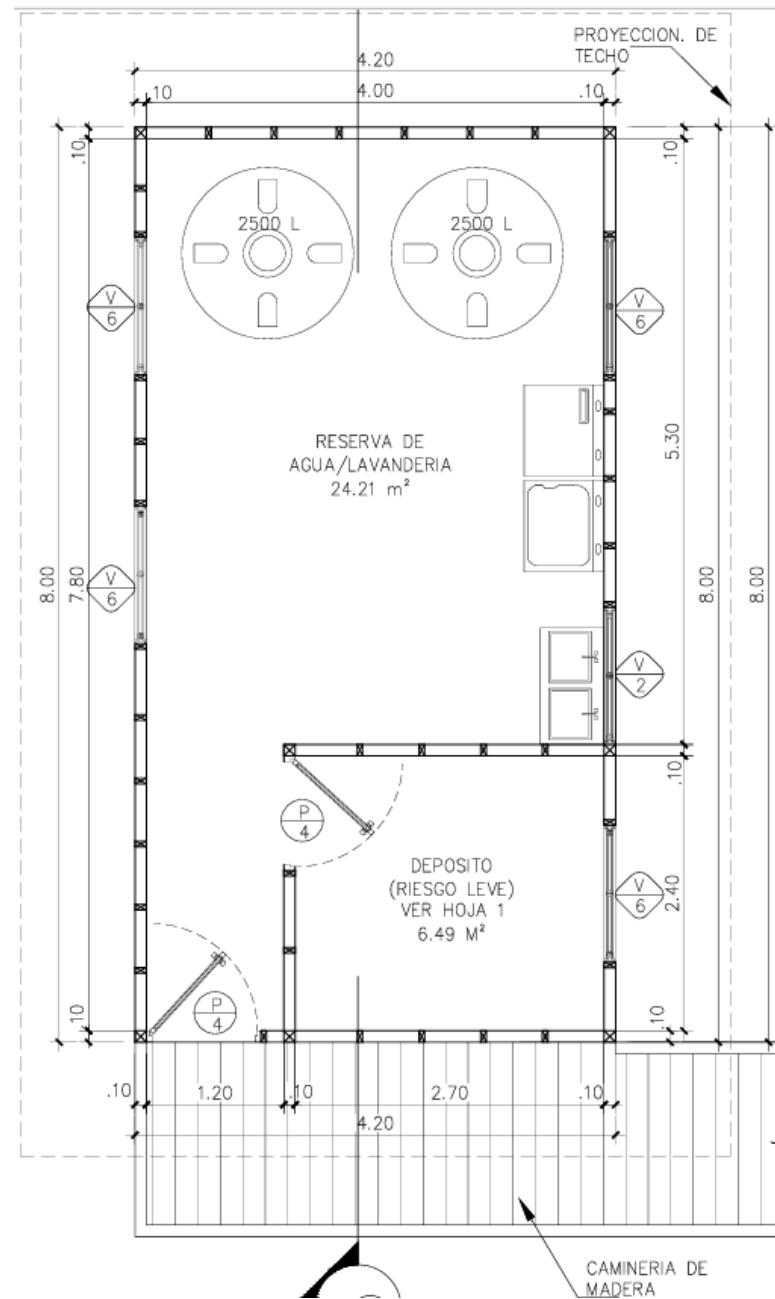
Vista en planta de plano arquitectónico de la lavandería.
